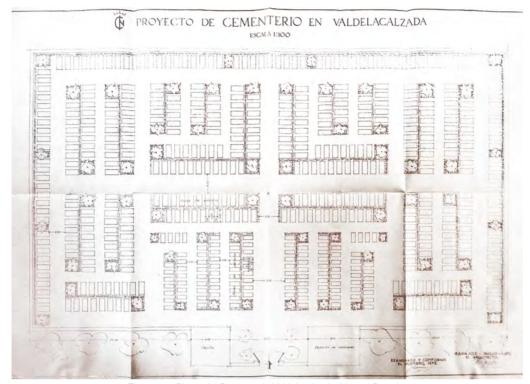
Planta del Proyecto de Valdelacalzada. Manuel Rosado.
